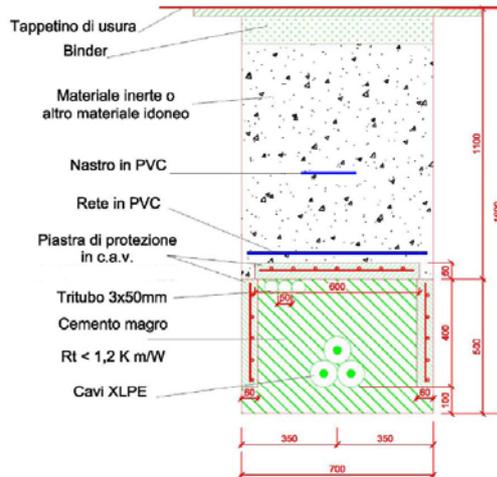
SEZIONE TIPO CAVIDOTTO AT
